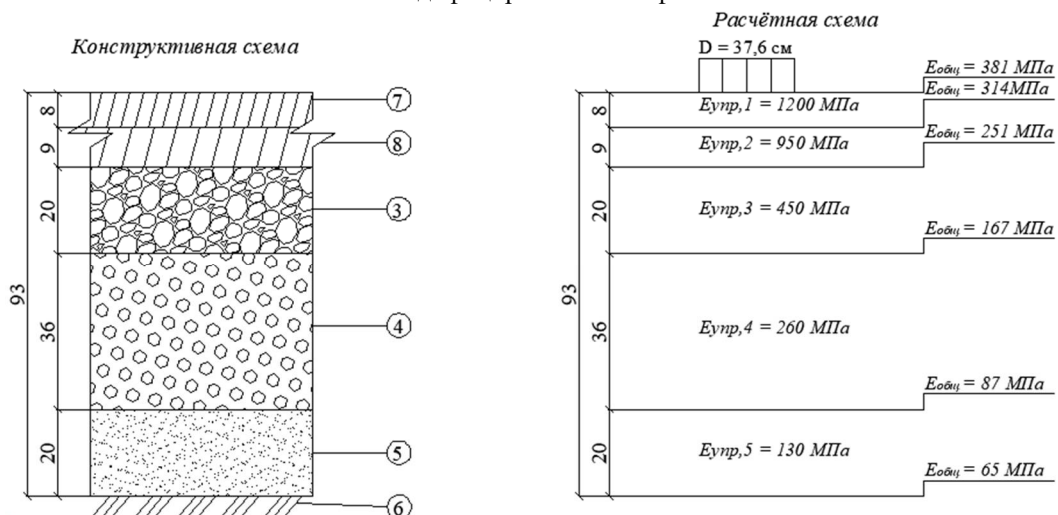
Конструктивная и расчетная схемы дорожной конструкции с покрытием из теплого асфальтобетона
